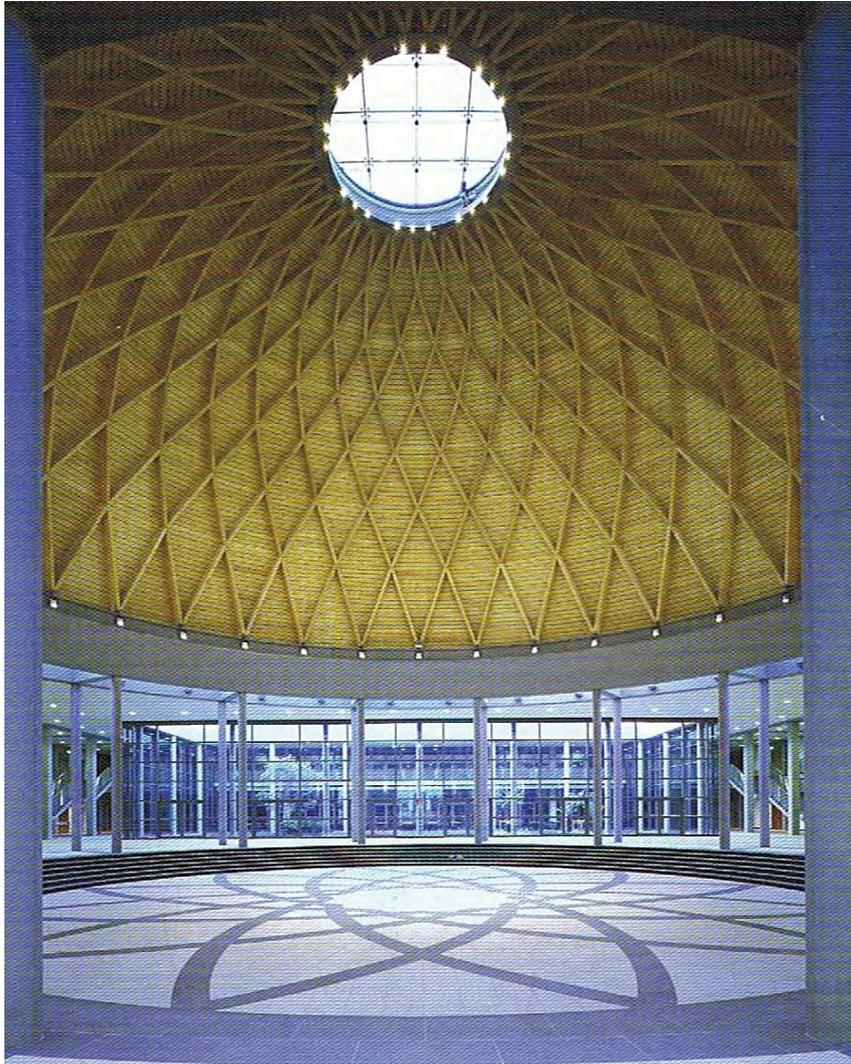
Neue Messe Rimini, Innenansicht der Kuppel, aus /137/
